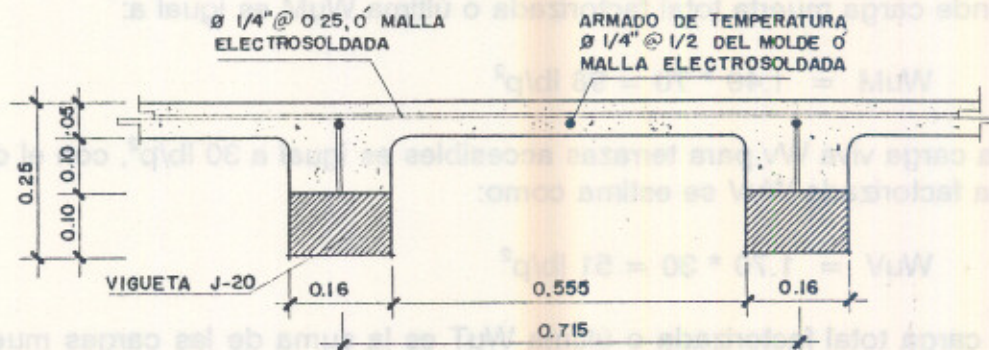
Sección típica de losa con molde LK y vigueta J-20
